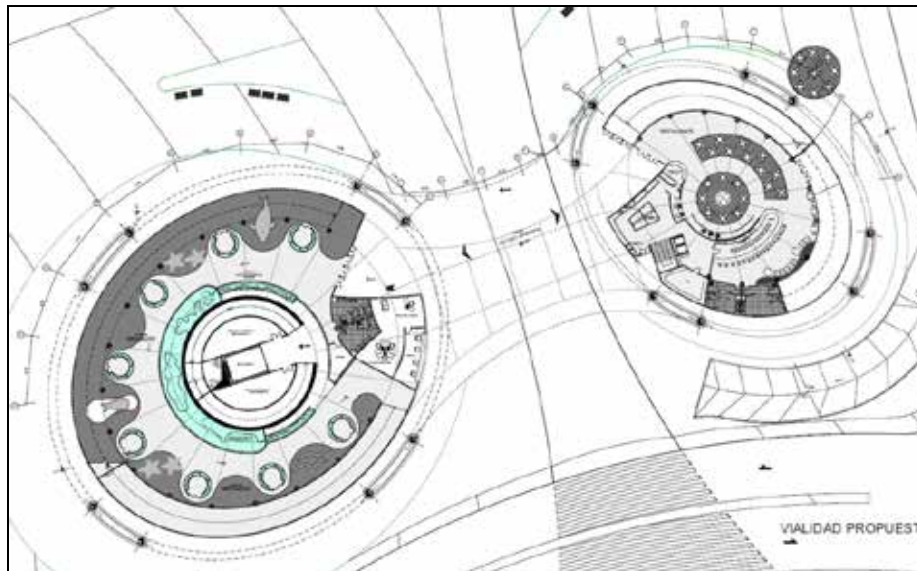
Planta Baja Nivel +/- 0.00. (2016).
